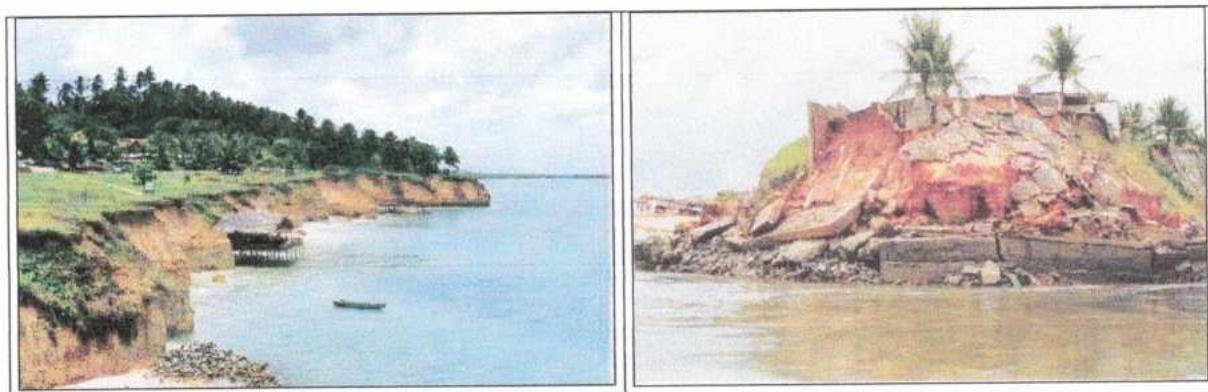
e 11. Detalhe de área de erosão de falésias com construção de restaurantes e escadas. Detalhe da destruição de muro de arrimo por ação das correntes marinhas, vendo-se a esquerda as barracas da Praia do Cachorro.
